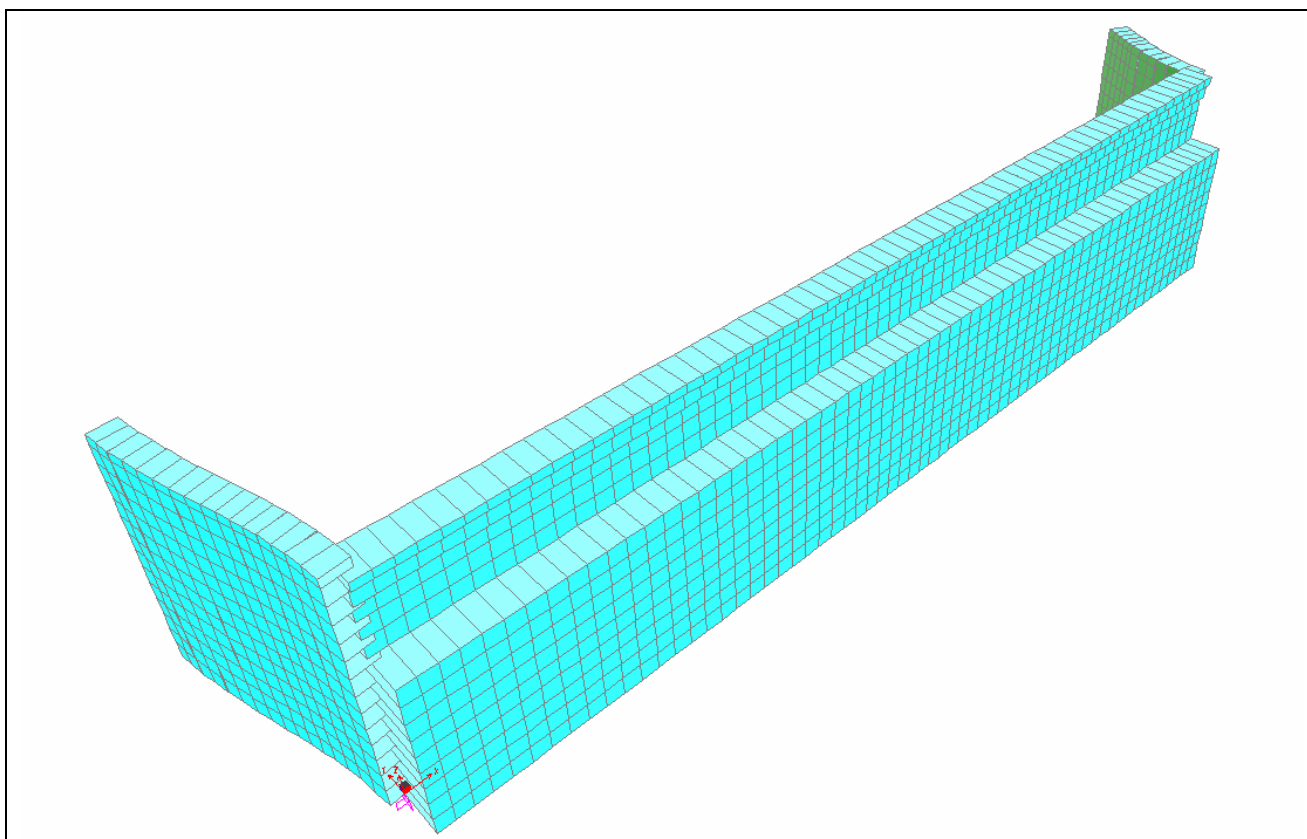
rappresentazione assometrica estrusa del modello di calcolo dei muri della spalla.
